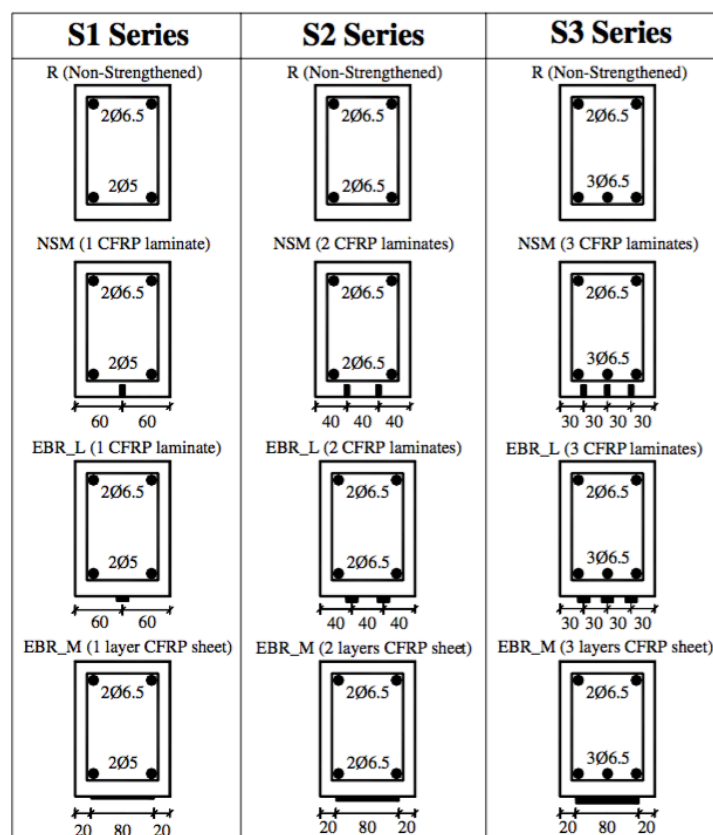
Seções transversais das vigas (Fonte: Barros *et al*, 2007)
